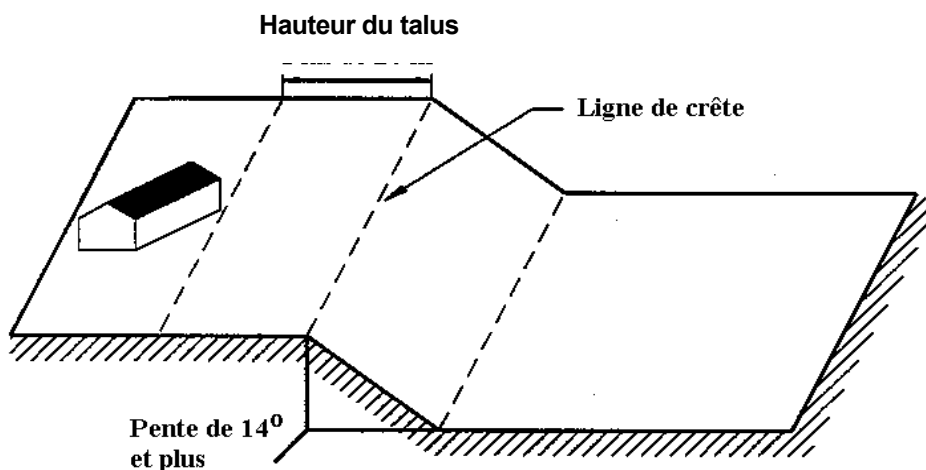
Implantation autorisée : implantation d'un bâtiment principal à une distance égale ou supérieure à la hauteur du talus.
